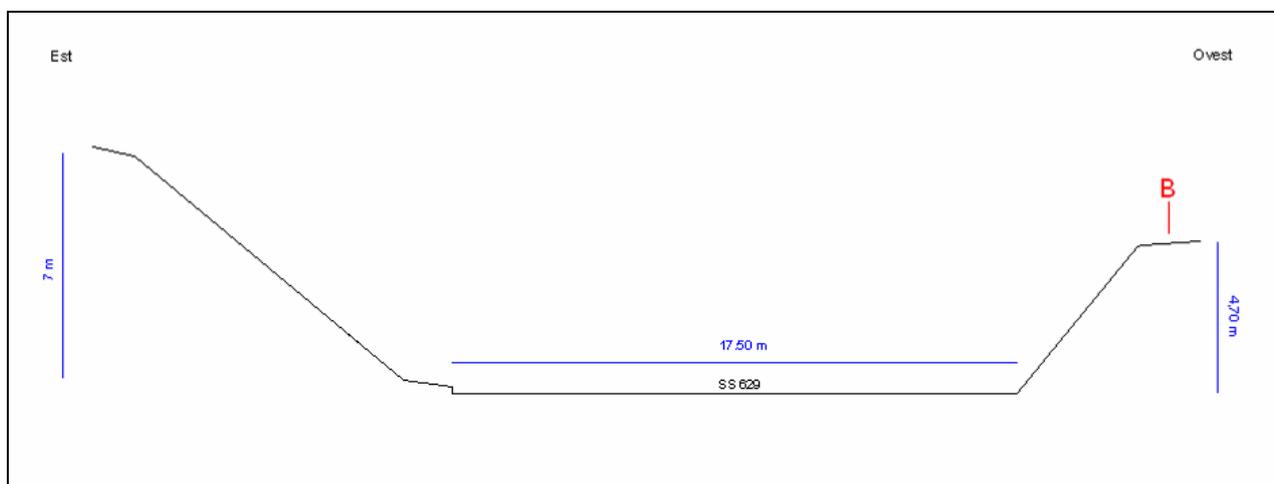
Sezione schematica del tratto stradale di interesse (SS 629)
